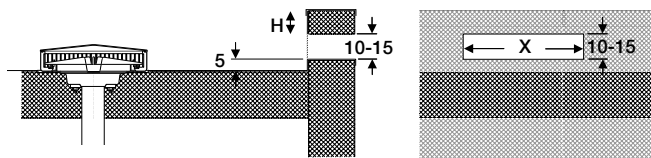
Аварийный перелив в случае плоской кровли, в фасаде
